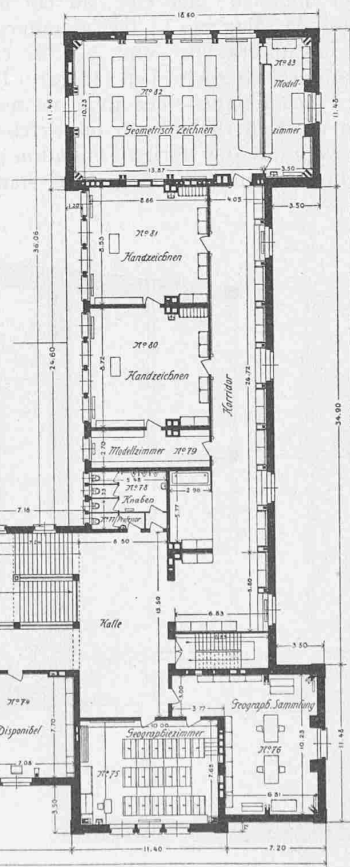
Grundriss des Dachstocks. — Masstab 1 : 500.
